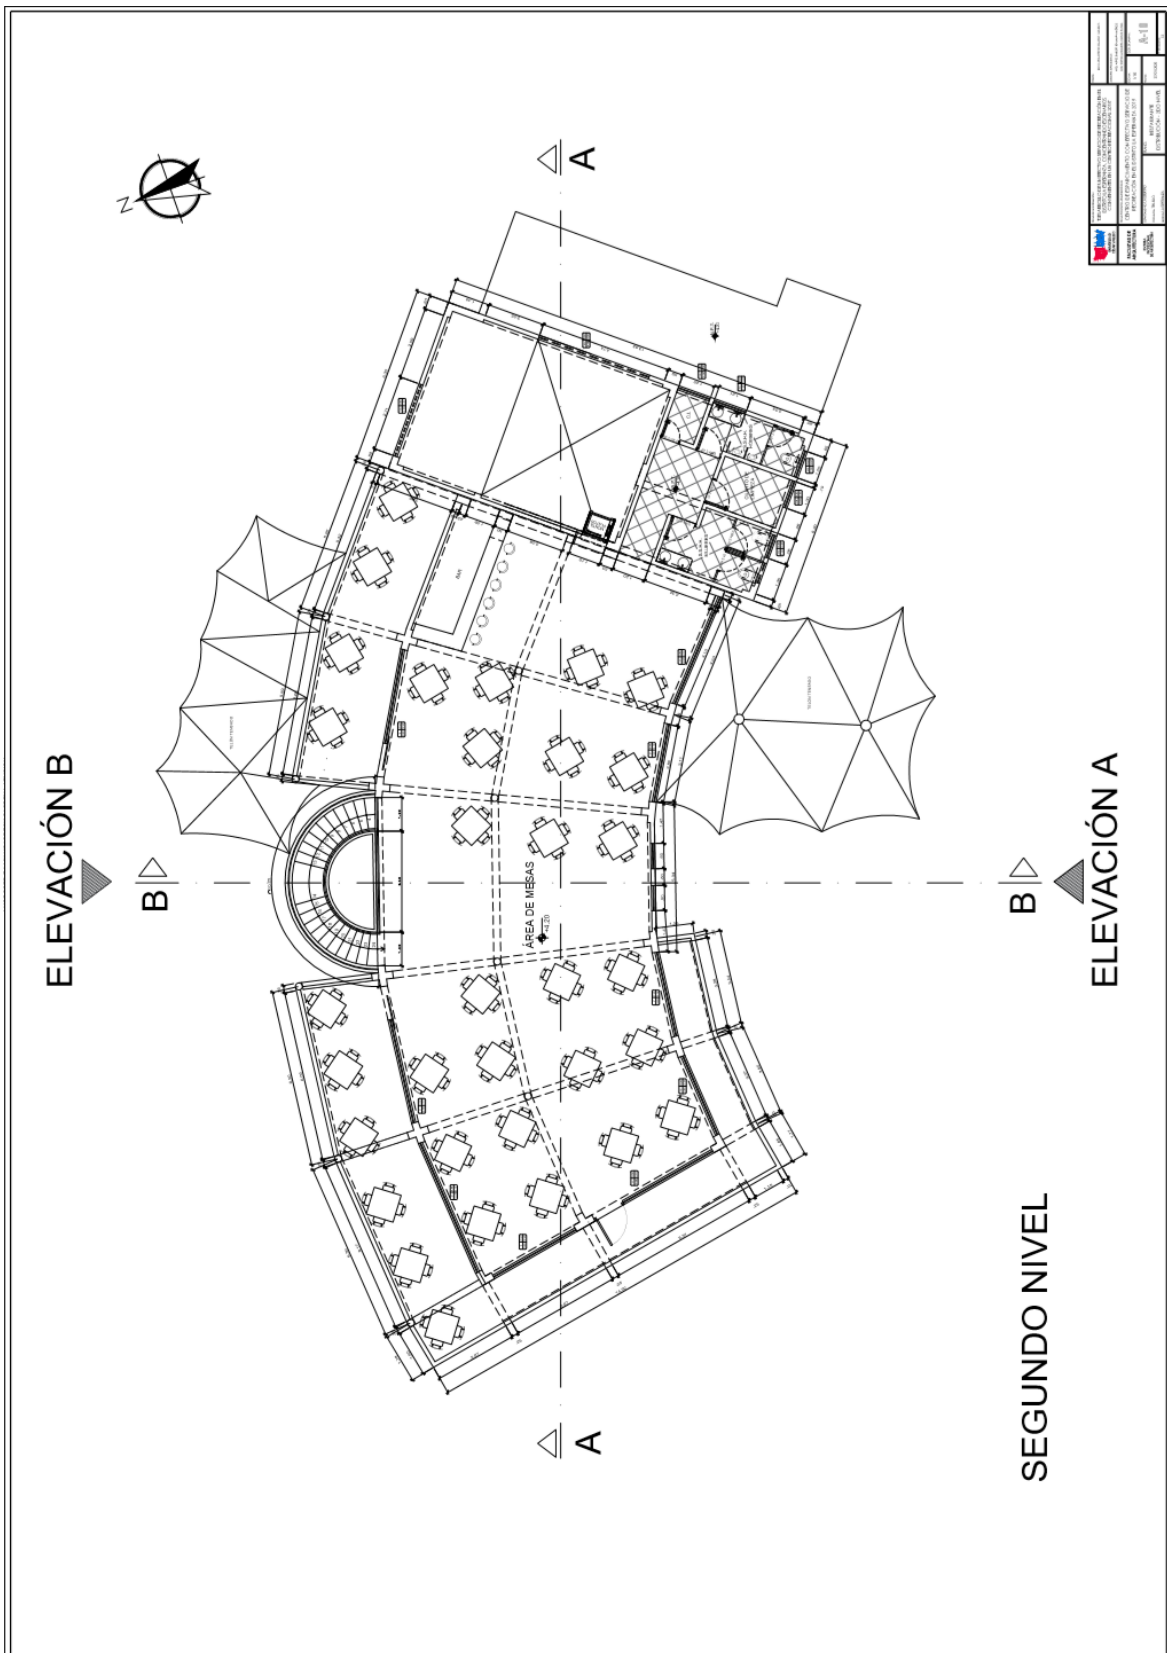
Plano de Restaurante- Distribución 2do piso. Elaboración propia.
